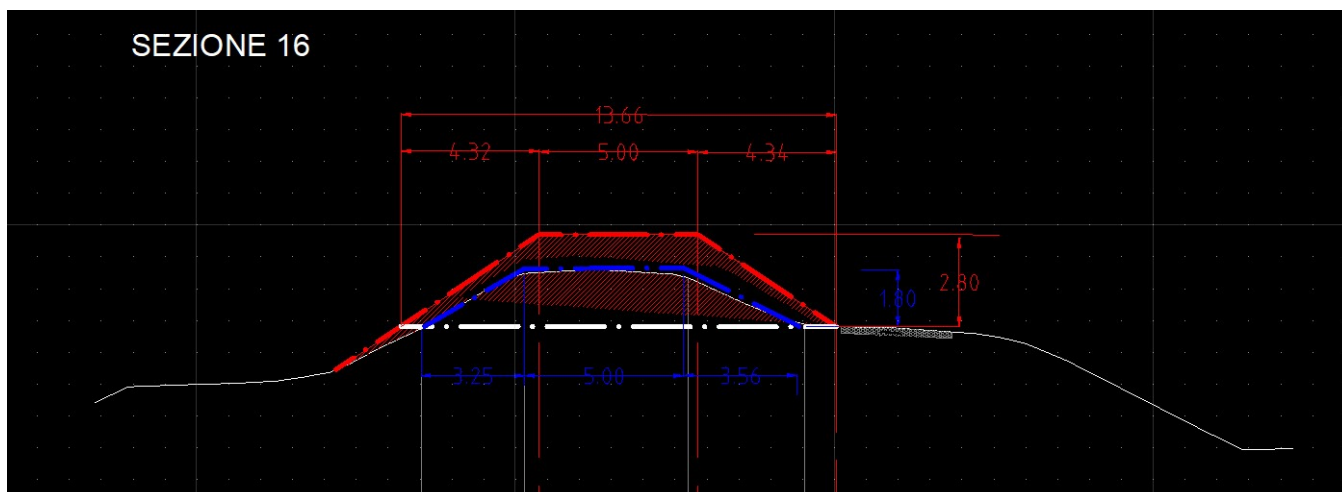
Sezione tipologica che prevede il rialzo arginale in asse rispetto alla sommità arginale attuale (estesa prevalente).
